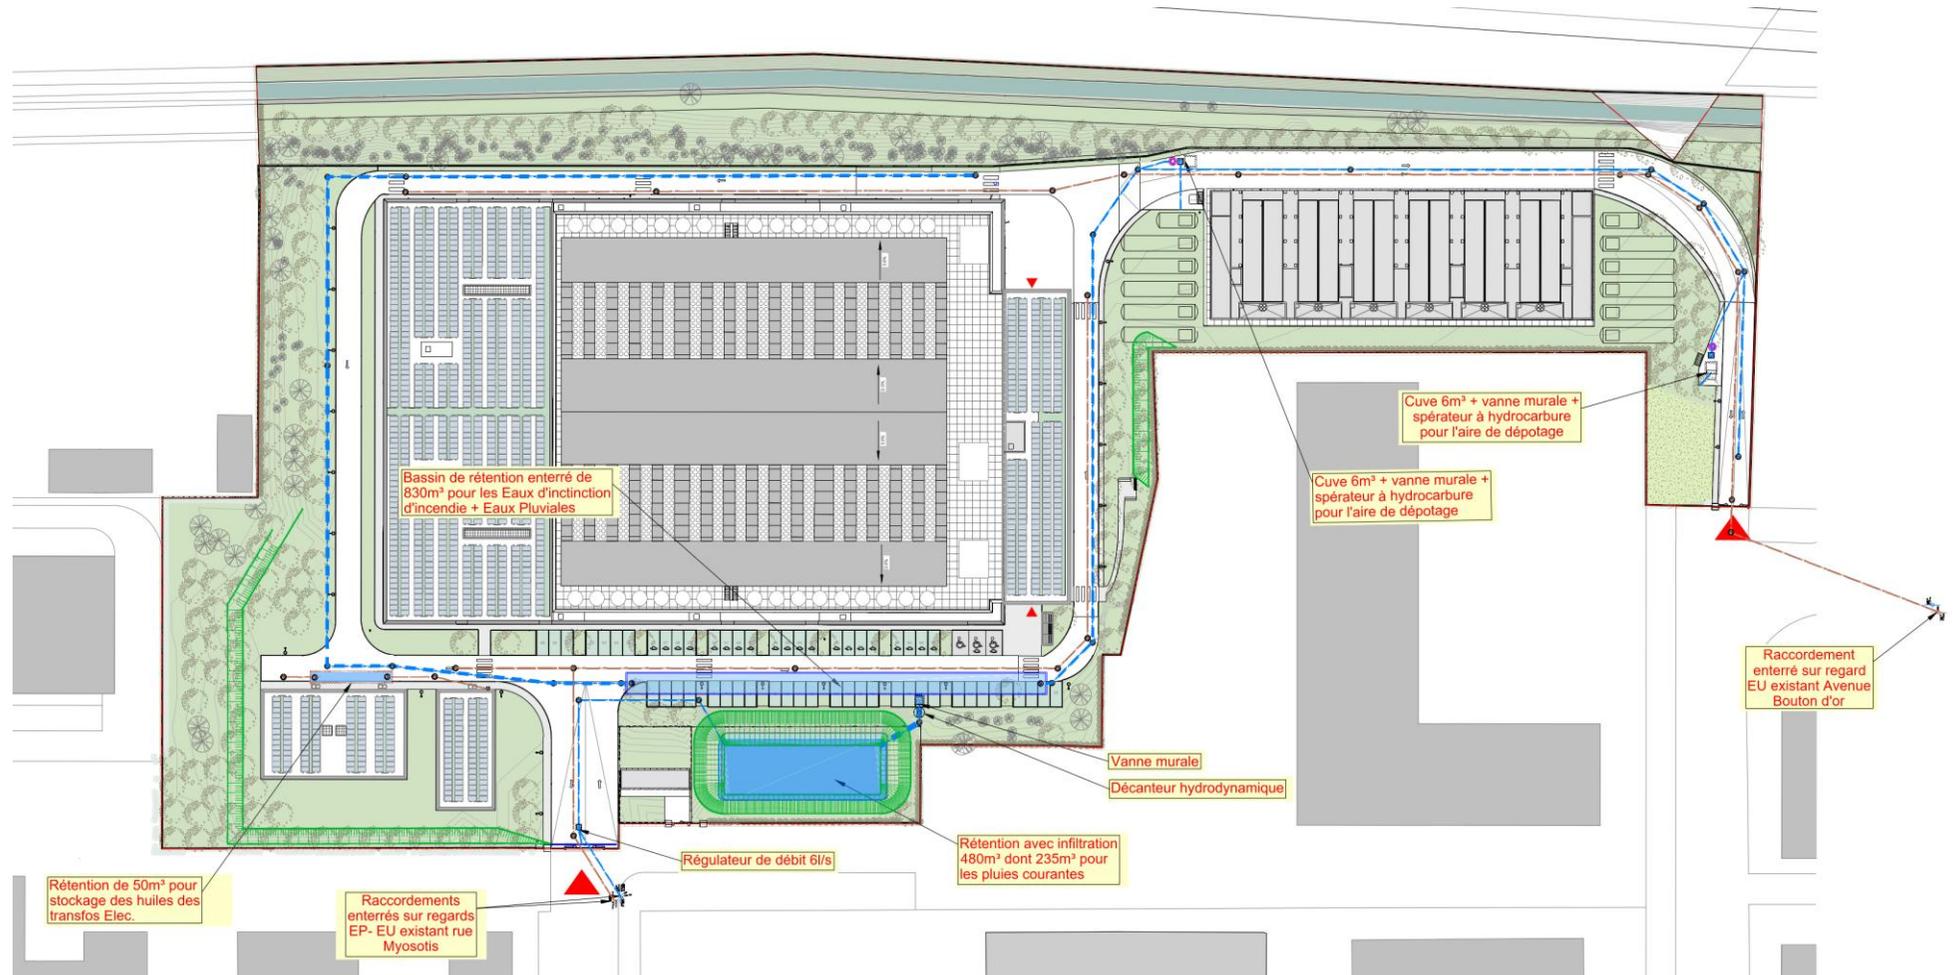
Plan des réseaux eaux pluviales et eaux usées
